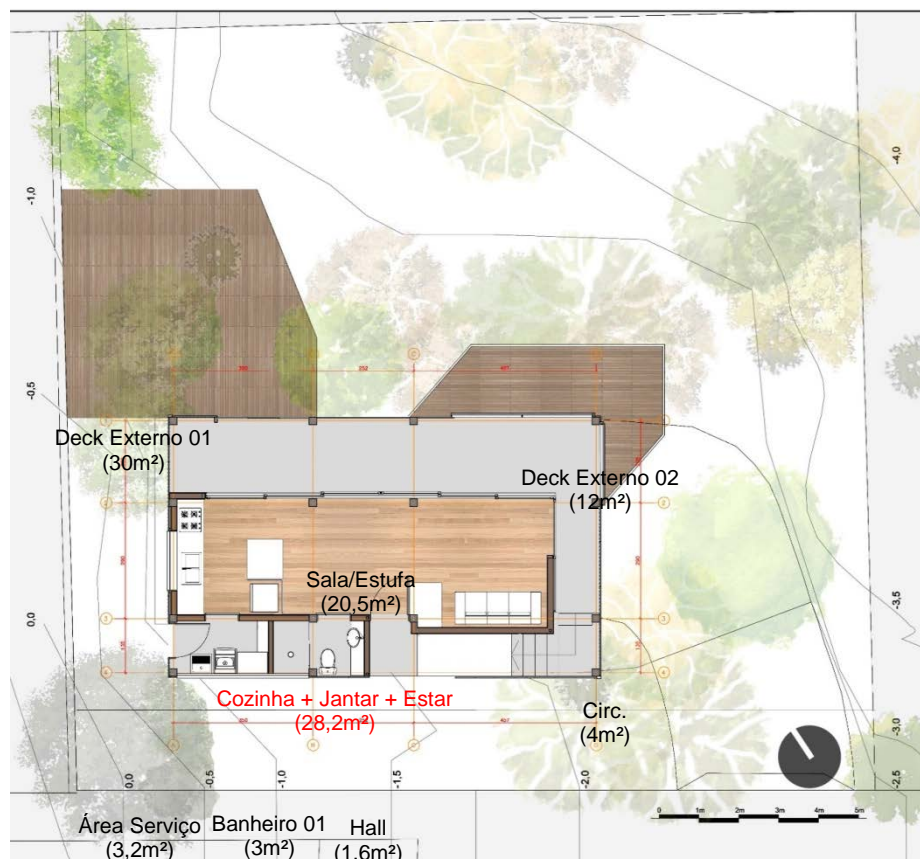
Planta baixa pavimento térreo. Zonas condicionadas em vermelho
